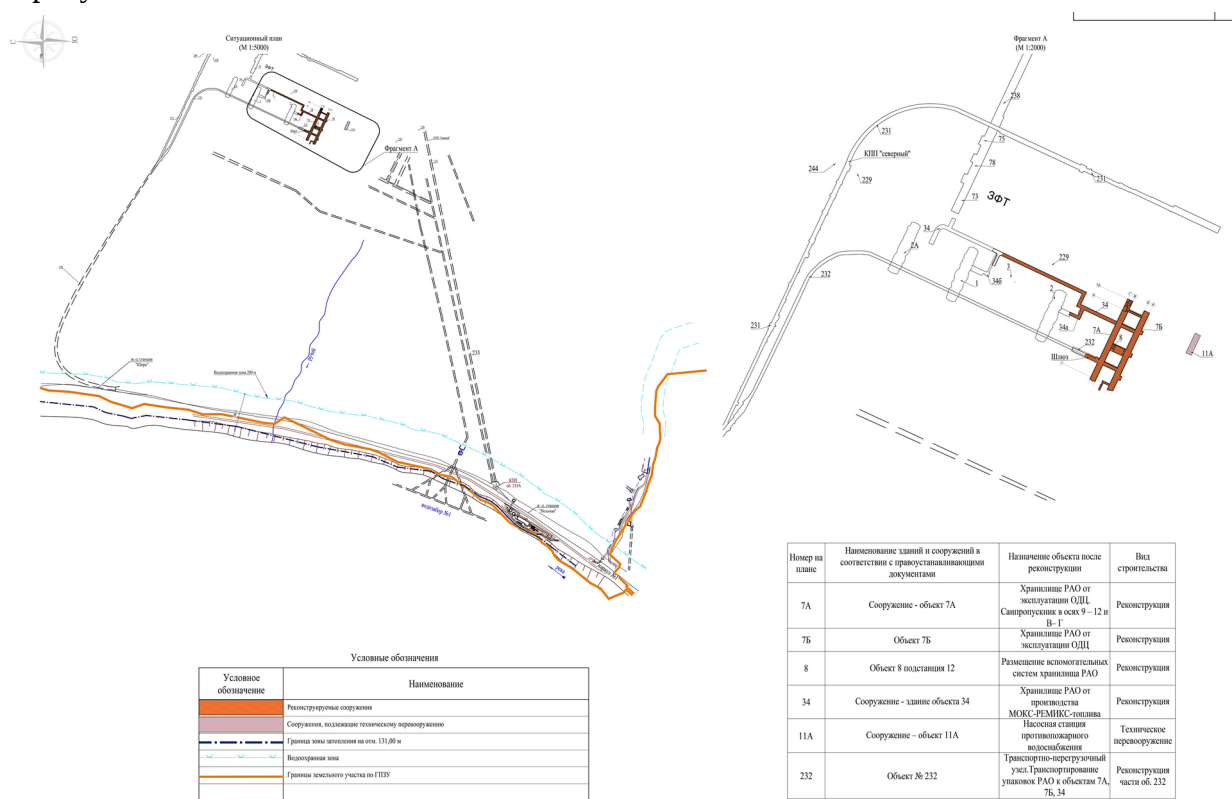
Фрагмент ситуационного плана размещения хранилища РАО второго класса с указанием границы землеотвода, границы зоны затопления и водоохранной зоны
